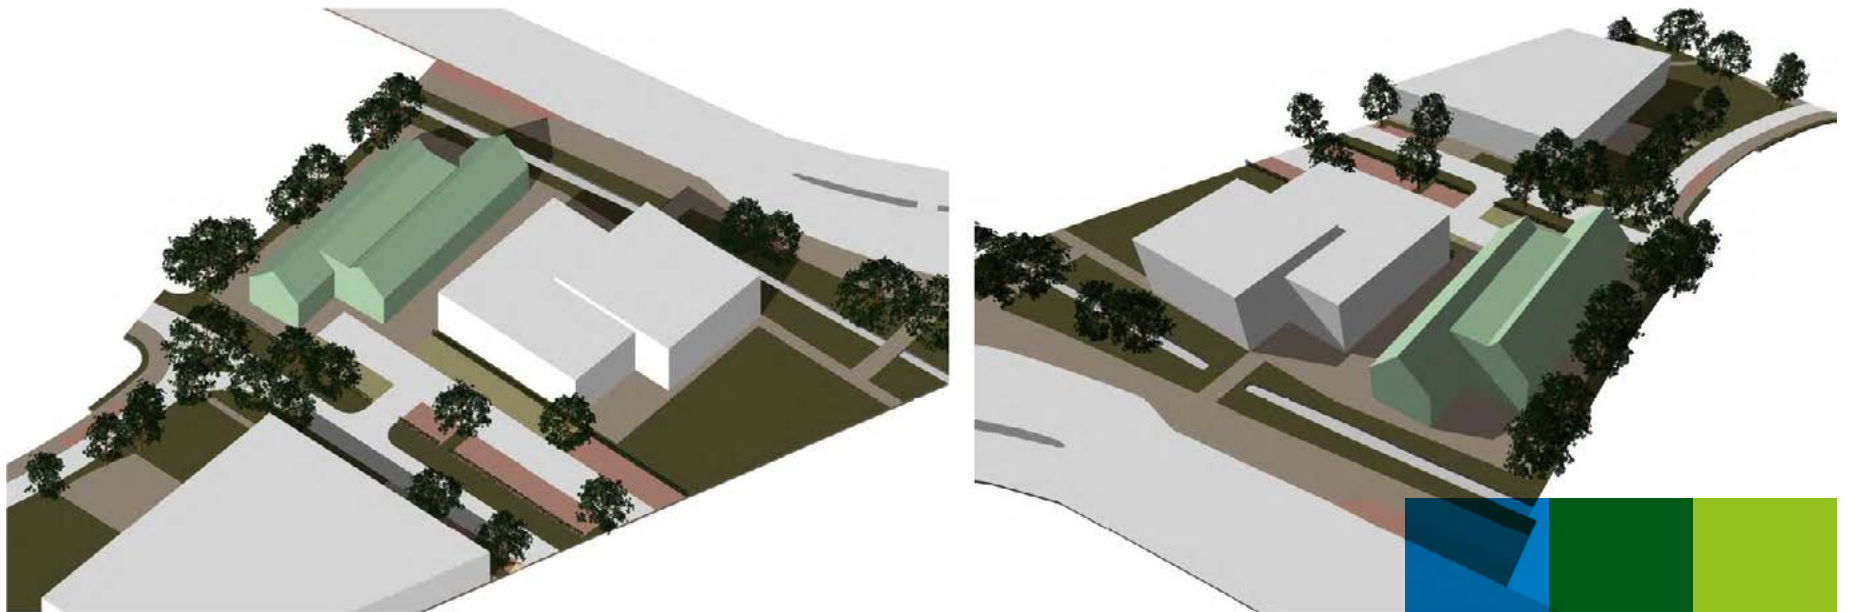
Plangebied Buitenplaats Rijnweijde met het perceel voor de beoogde uitbreiding van Het DOK
